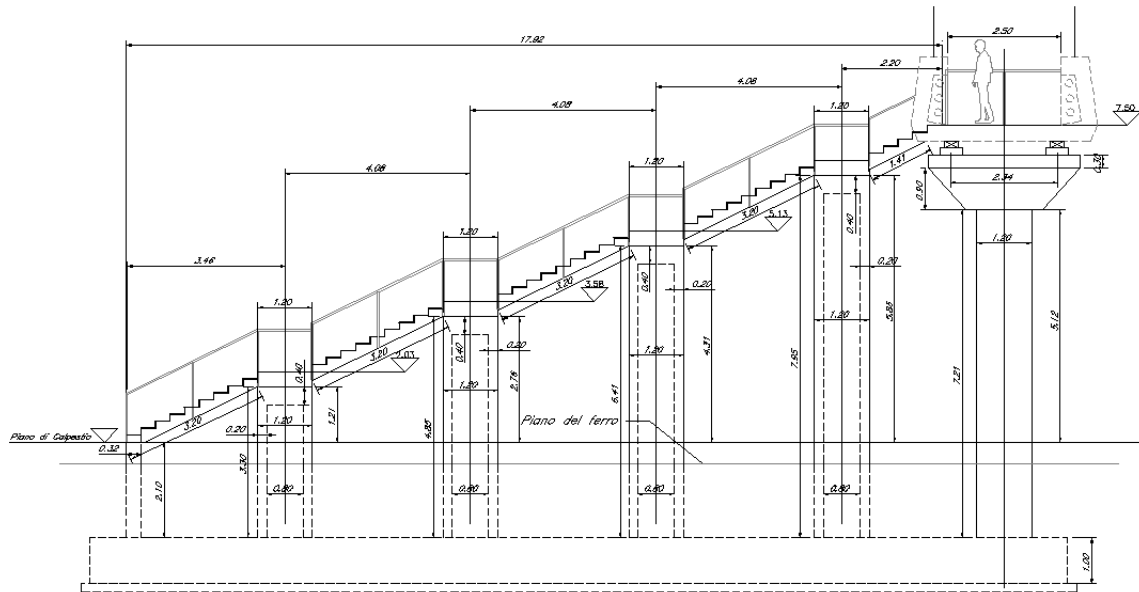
Sezione longitudinale del sovrappasso pedonale
